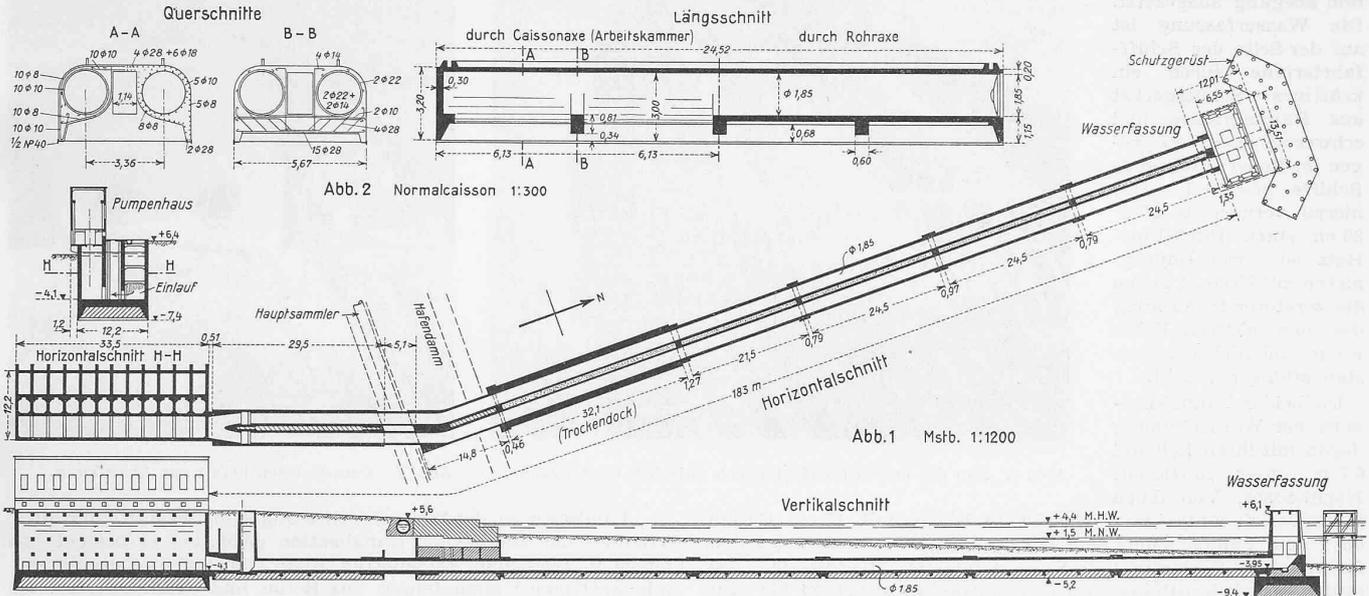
Grundriss und Aufriss der Kühlwasserleitung zum Pumpenhaus, 1 : 1200. — Abb. 2. Normal-Caisson der Zwillingsröhre, 1 : 300.
